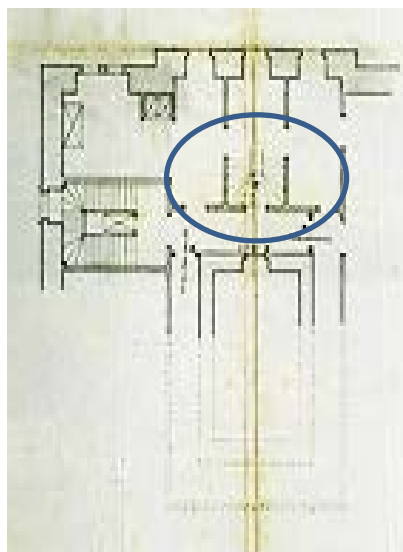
P R C - Planta do piso inferior. Alterações no interior.⁴¹
